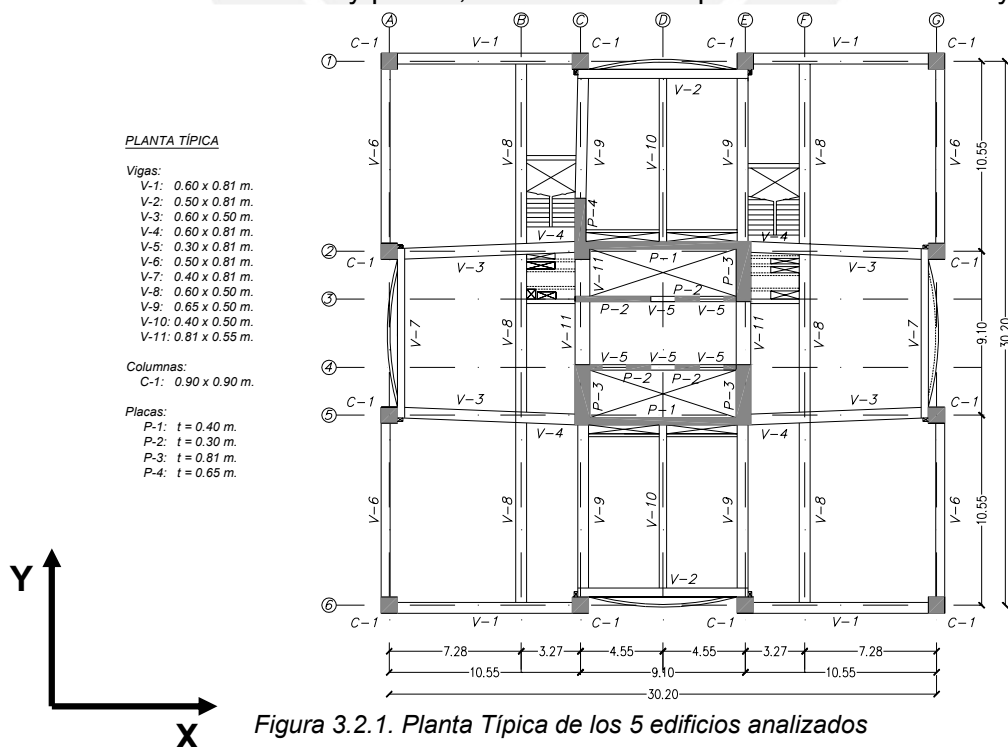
Planta Típica de los 5 edificios analizados
